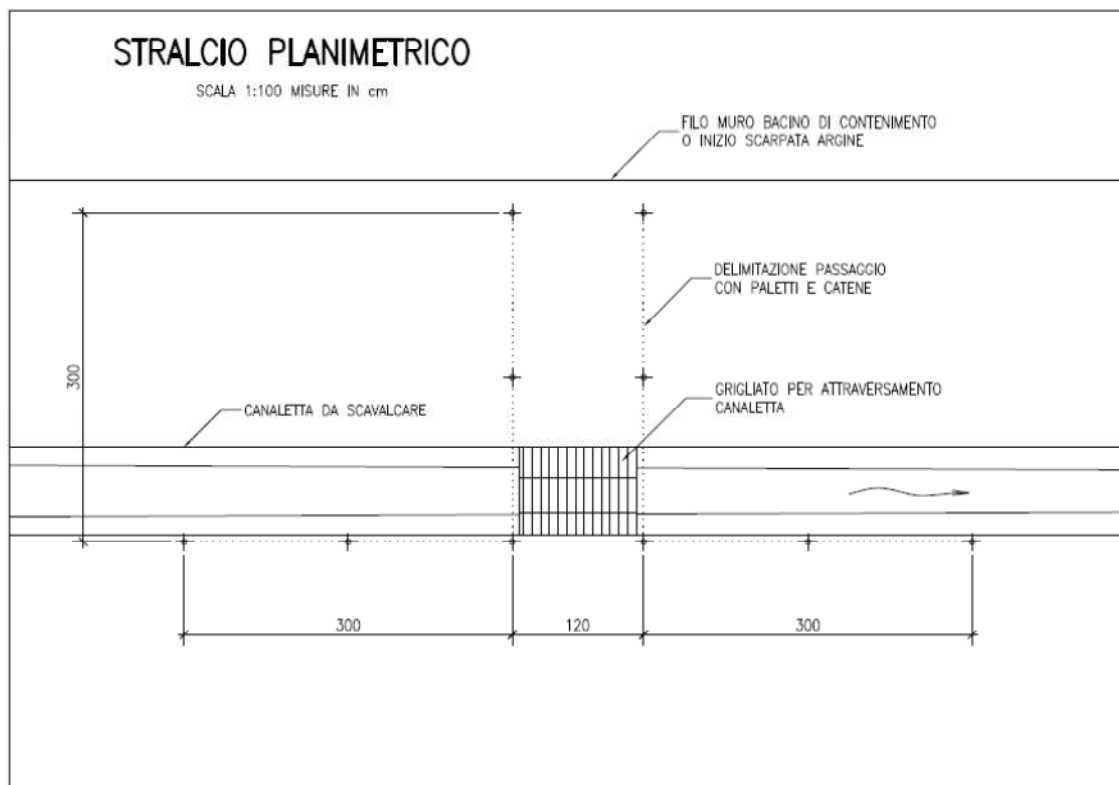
Stralcio Planimetrico per scavalco canaletta circolare (Typico)
